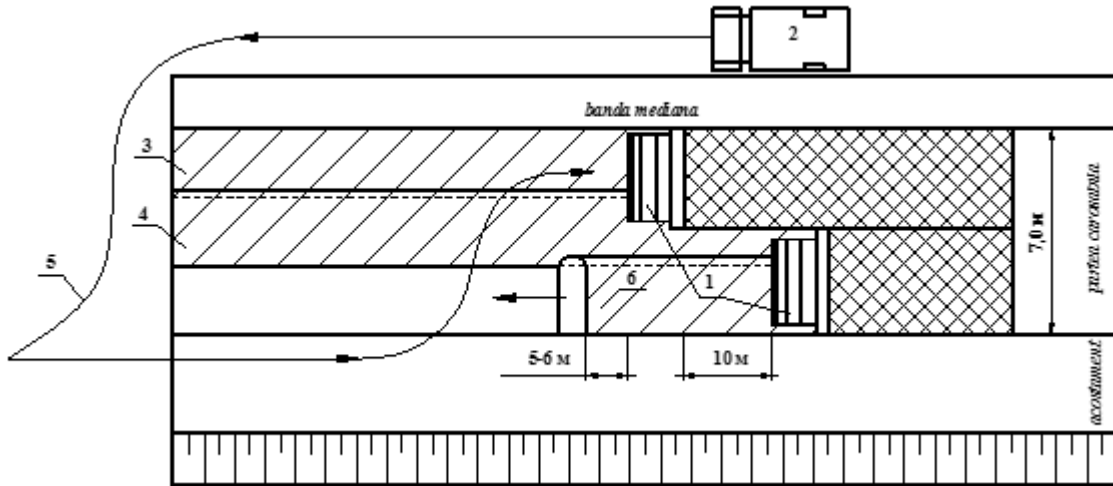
Схема выполнения работ по укладке ГМ при устройстве покрытия одновременно на ширине более 6 м
